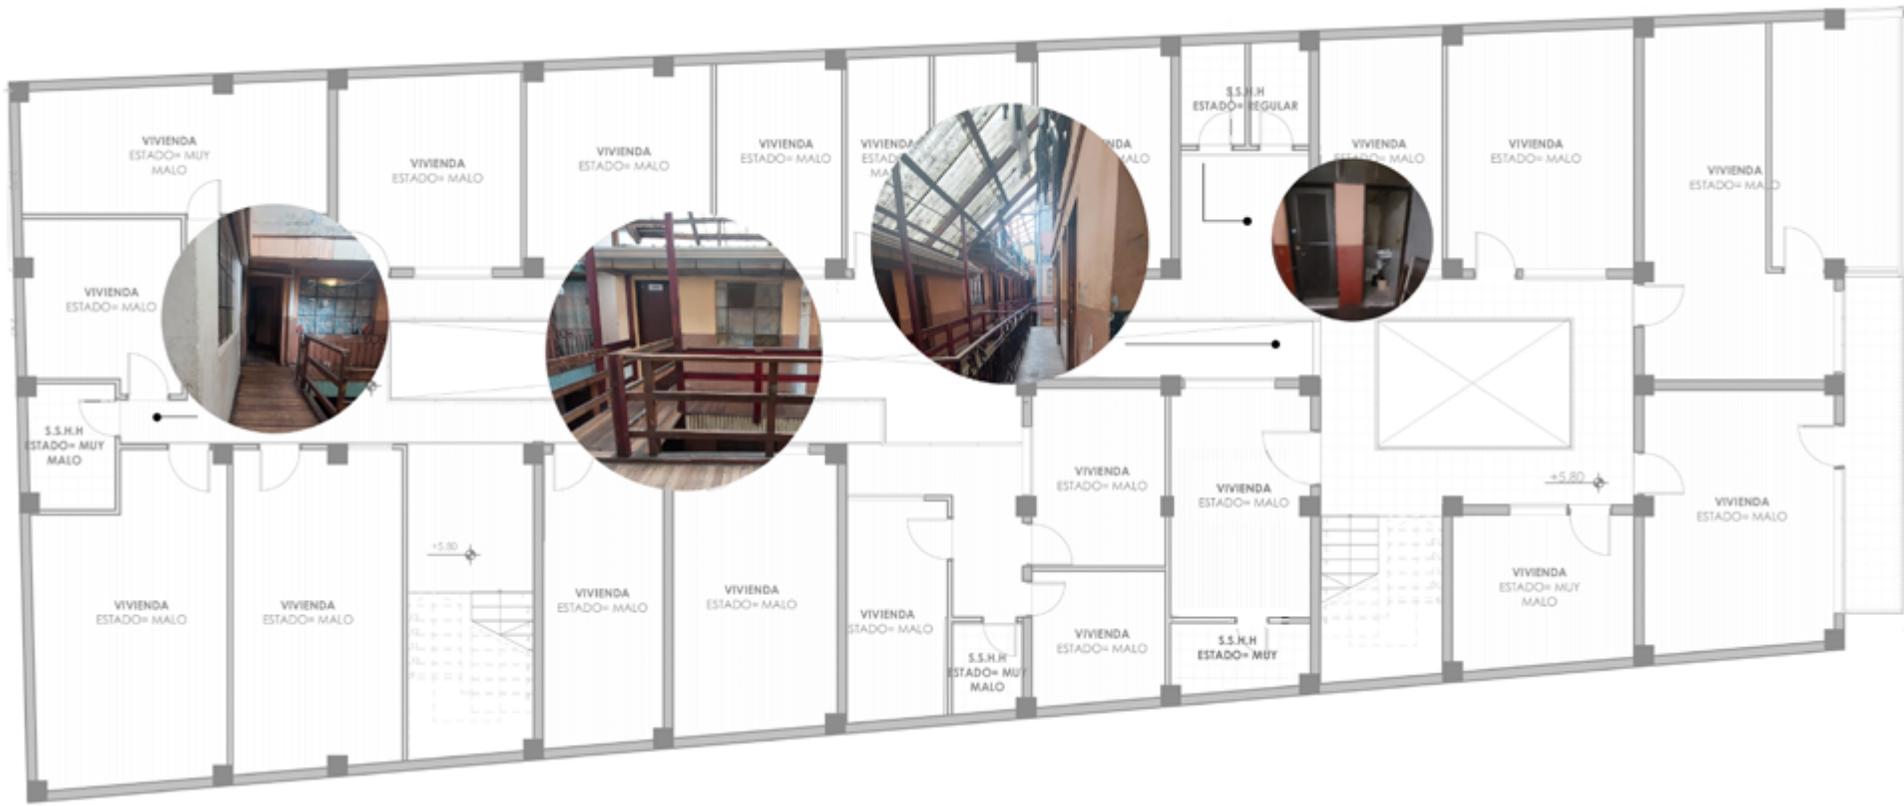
Vistas al rededor de la segunda planta alta. Autoría propia [Fotografía e ilustración].
